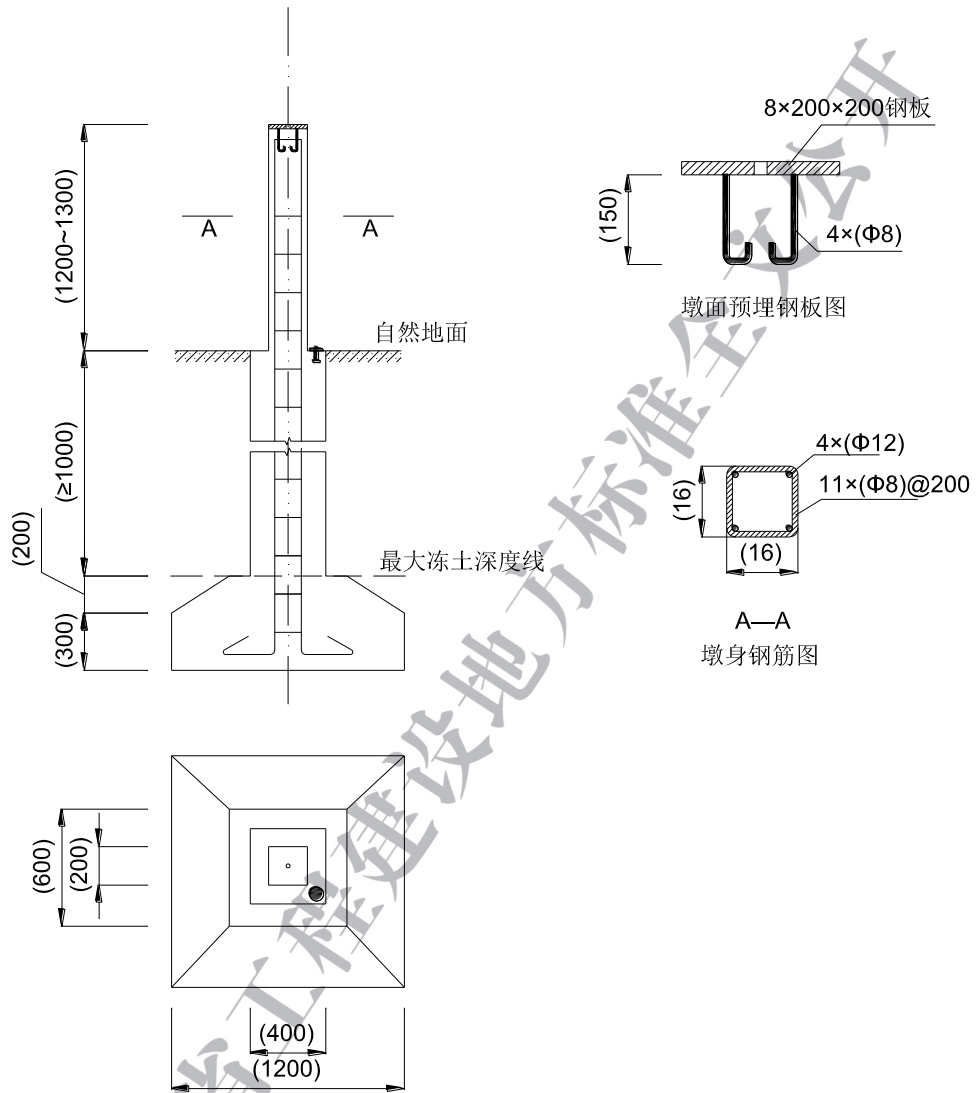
钢筋混凝土强制归心观测墩埋设 (单位: mm)
